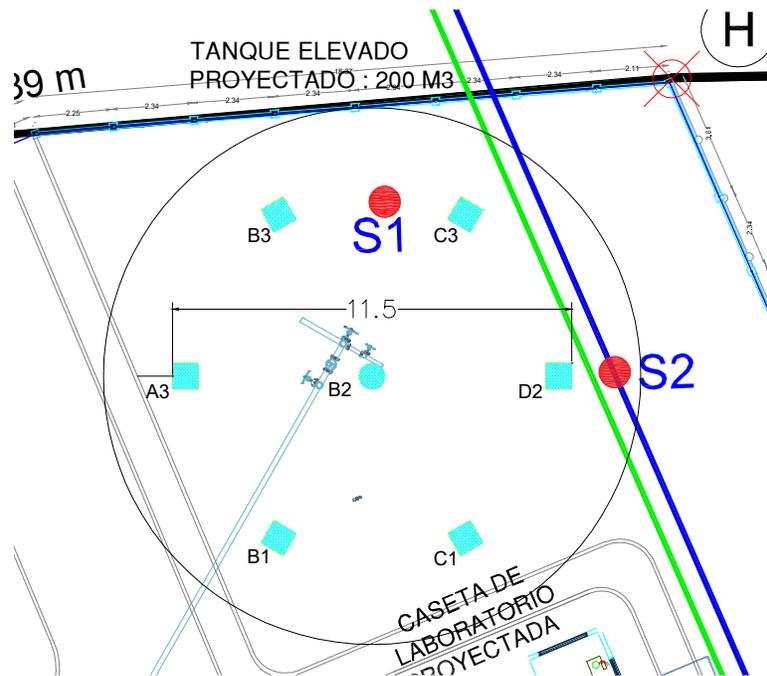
Imagen tomada de “Plano con Sondeos Ubicados.dwg” donde se observa que la distancia entre columnas es 11.5m (mayor que la losa de cimentación recomendada)
